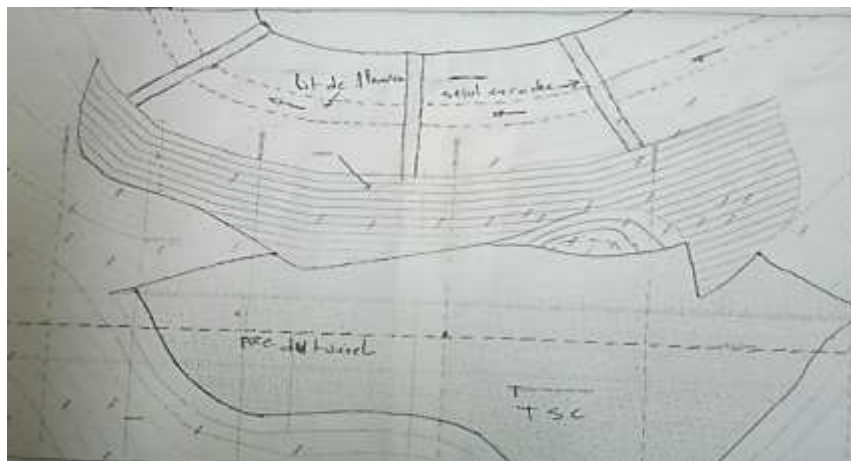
Vue en plan de terrain stabilisé avec ciment.
